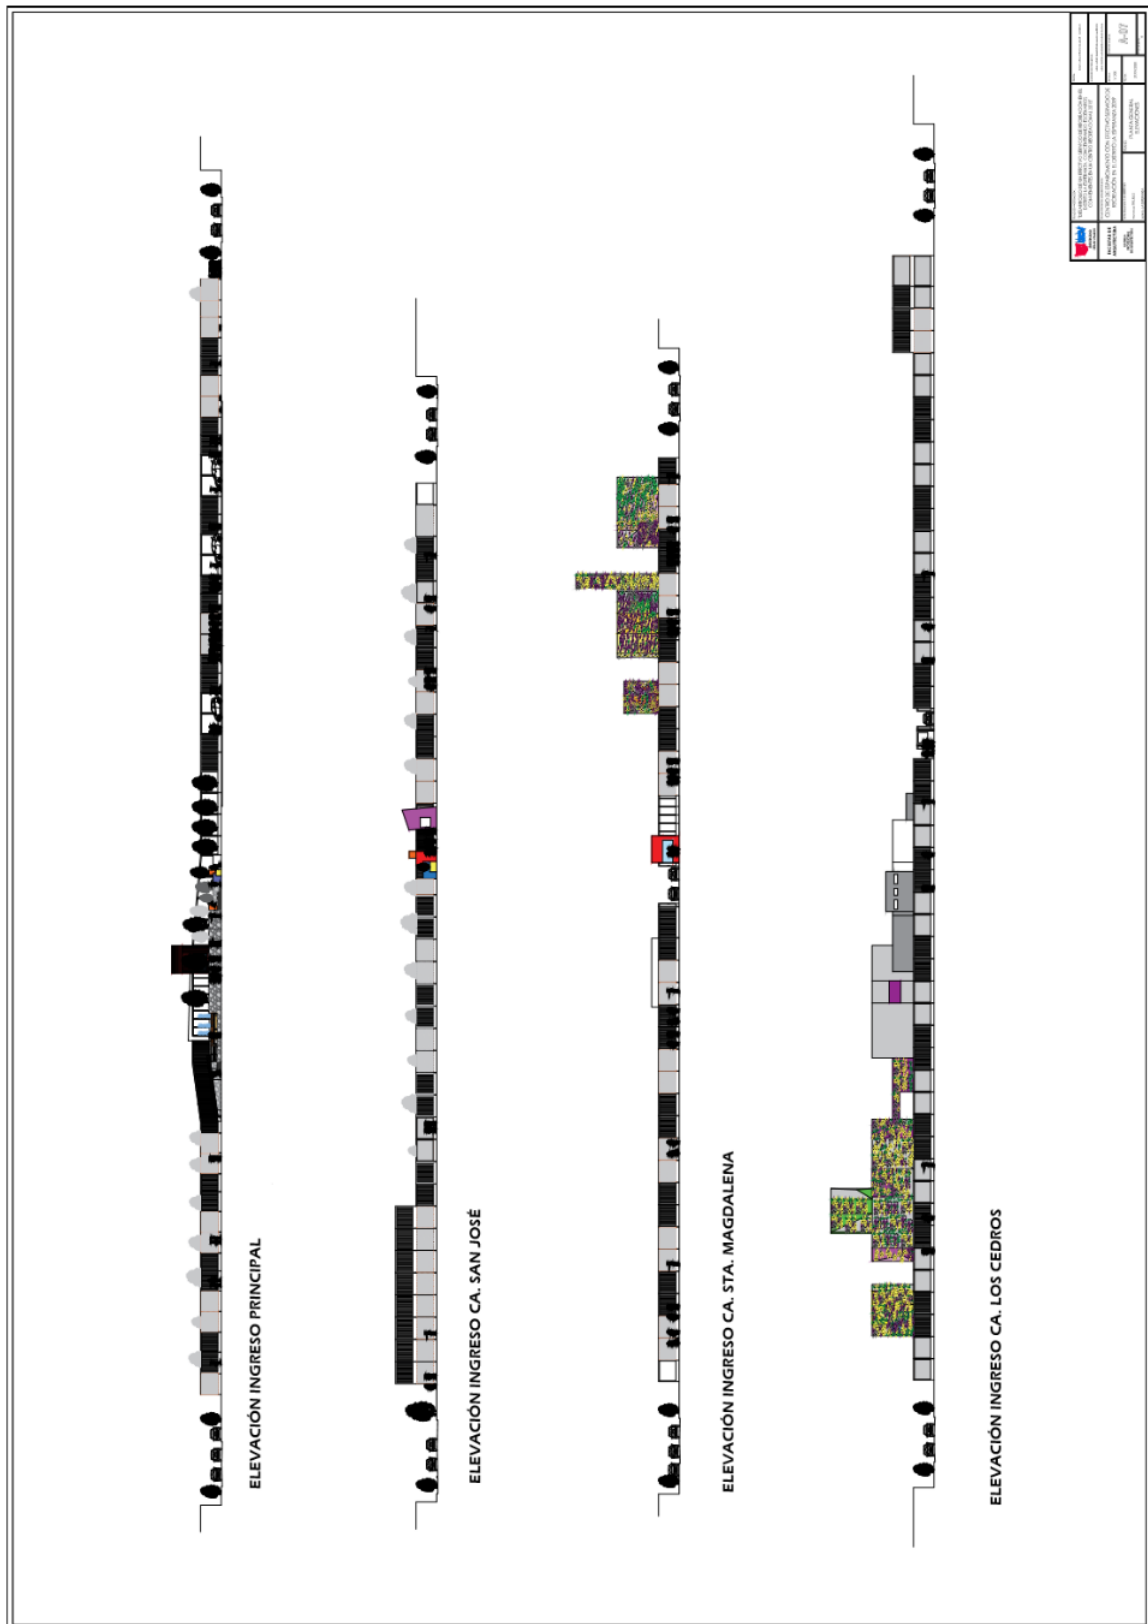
Plano de Elevaciones de Fachada. Elaboración propia.
